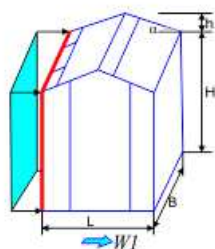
Схема приложения ветровой нагрузки на навстрелнную сторону
